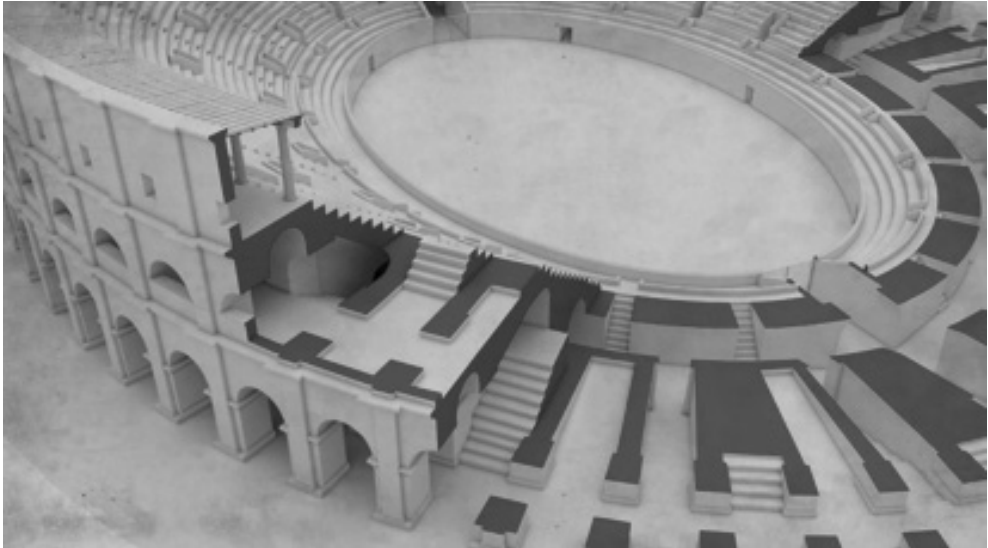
e 9. Sezione prospettica e longitudinale dell'anfiteatro.
